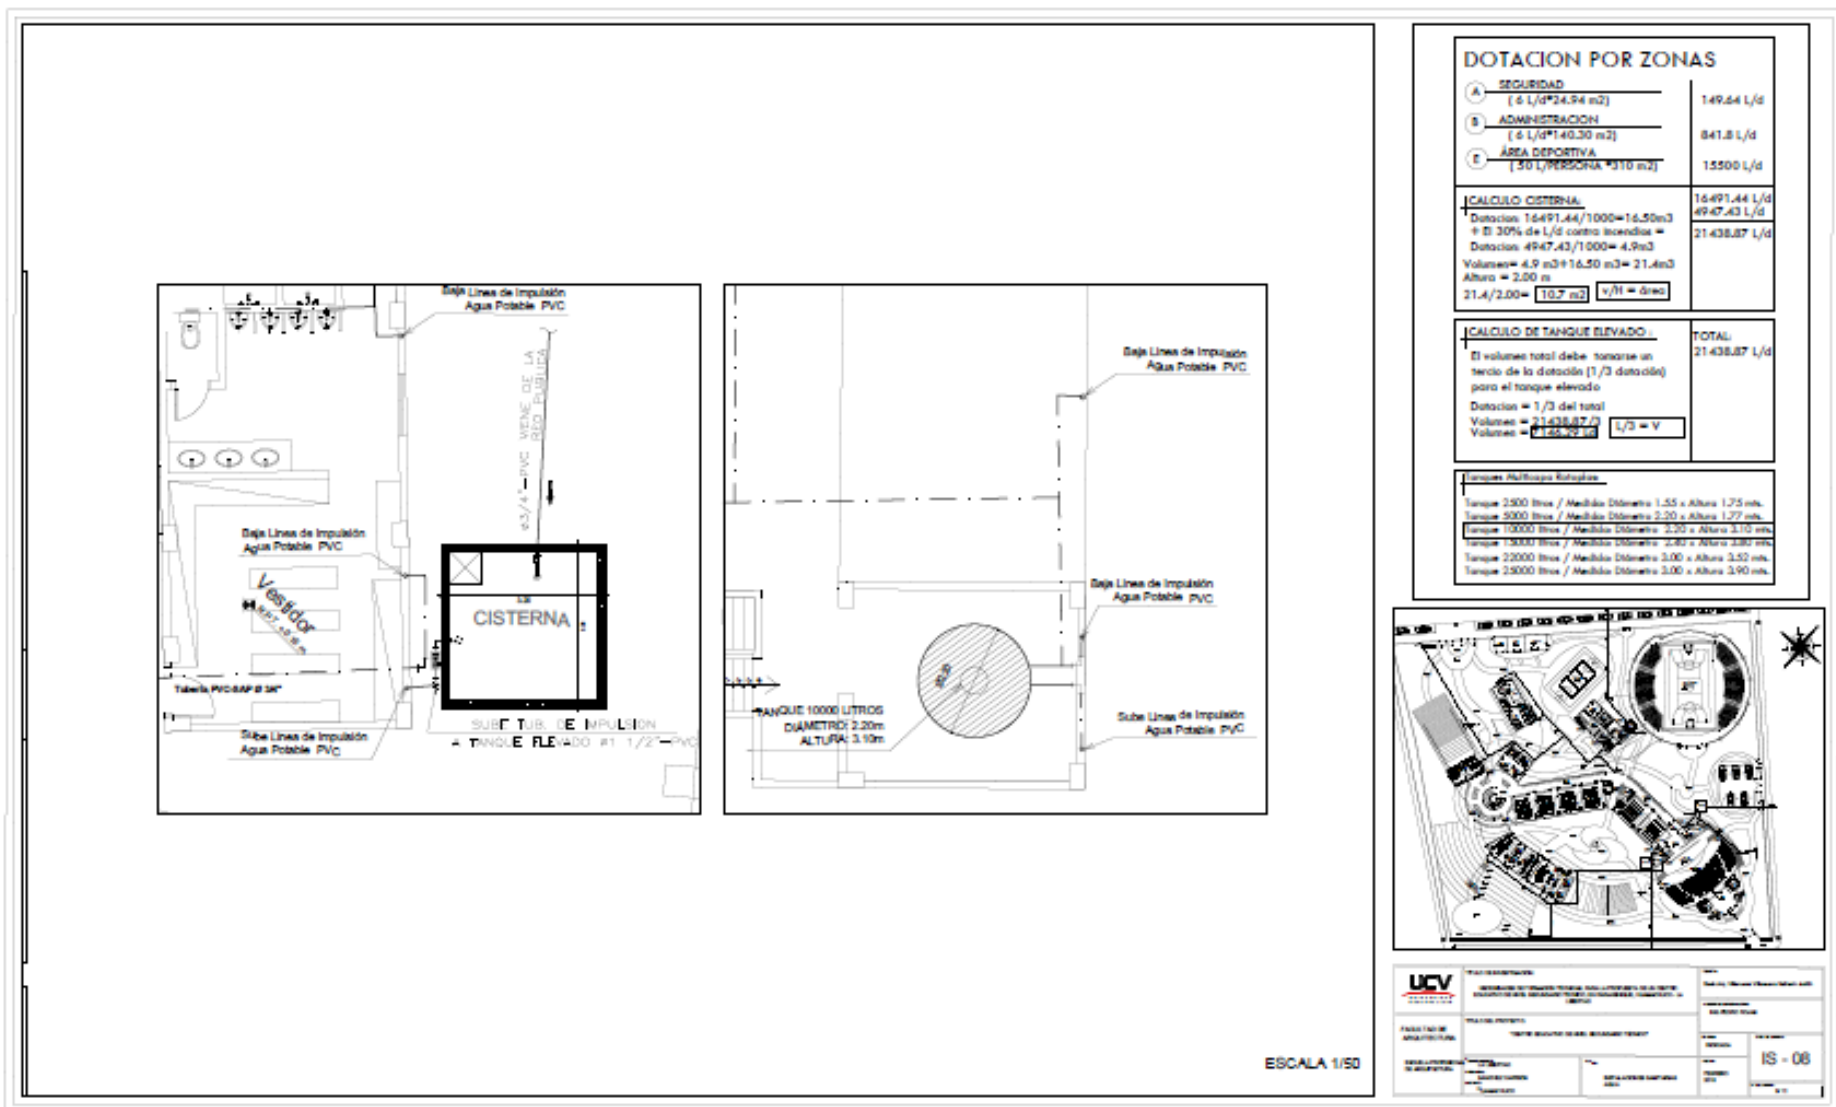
Plano de Diseño de Instalaciones Básicas Detalle – Agua - Plano N° 28 - Lamina IS-08
